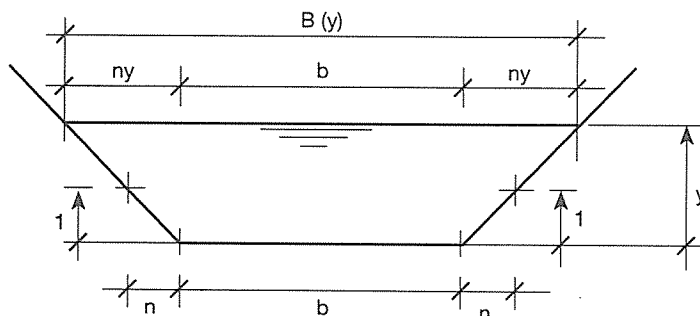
Symmetrisches Trapezprofil mit Böschungsneigungen 1 zu n.
